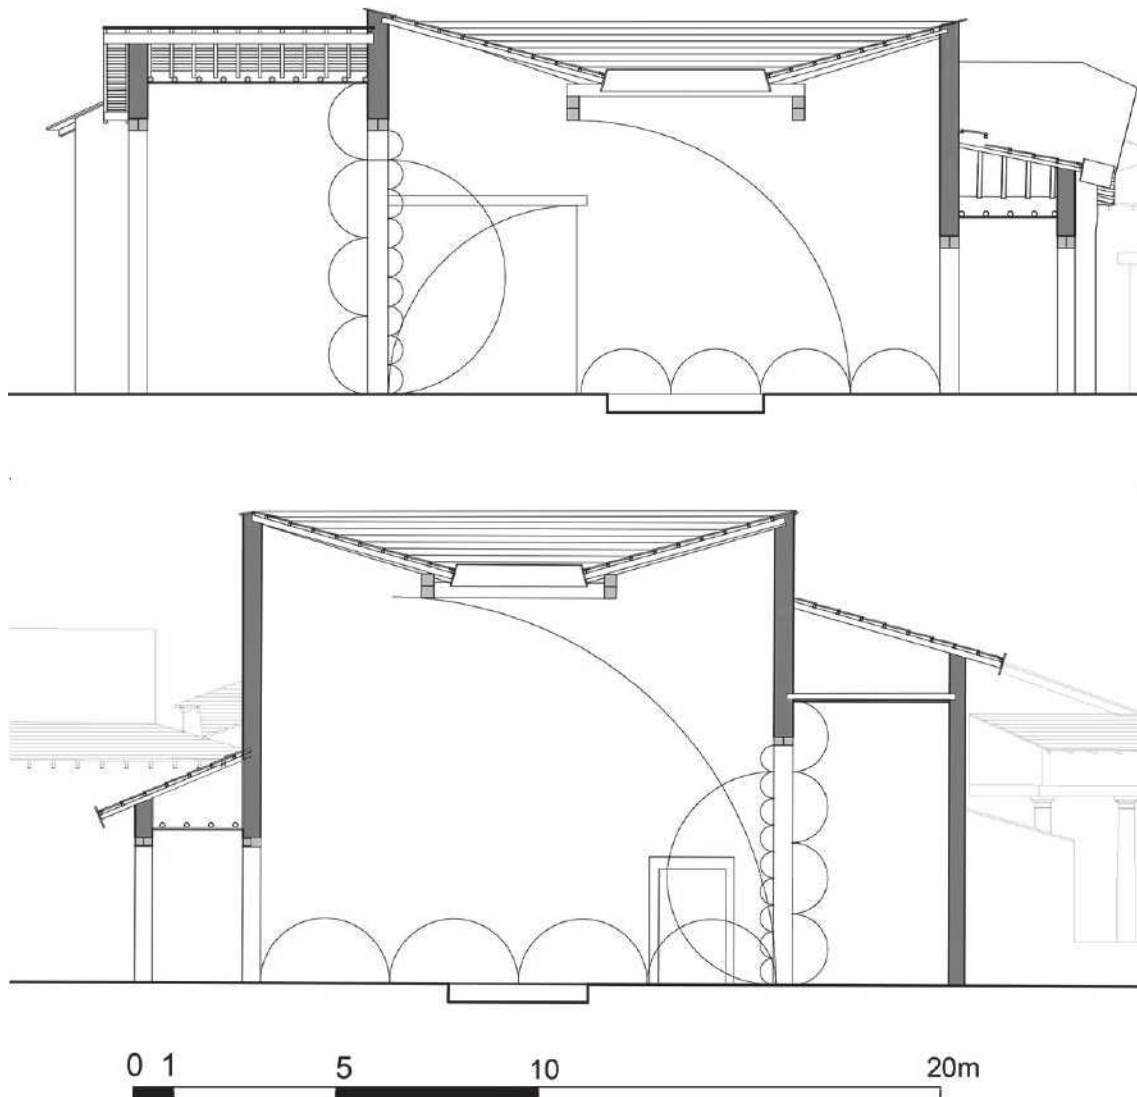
Sezione trasversale con l'interpretazione della costruzione geometrica proposta da Vitruvio.
